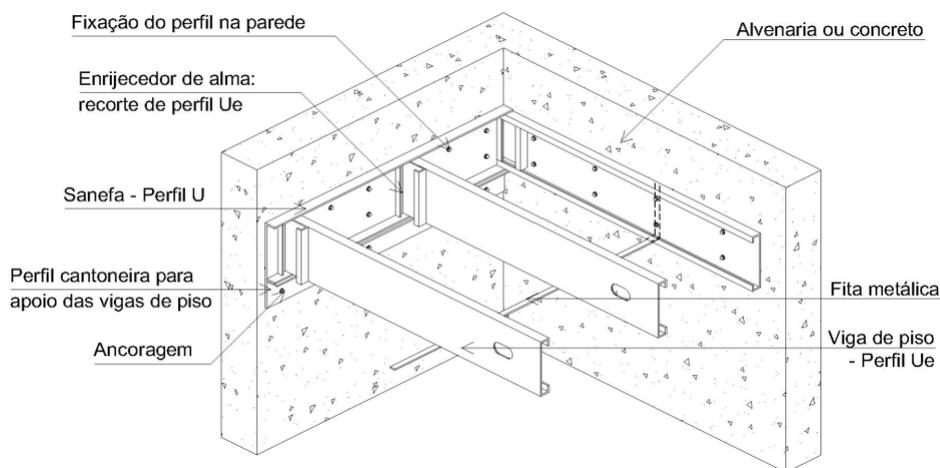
Laje em Steel Framing apoiada sobre estrutura tradicional.
